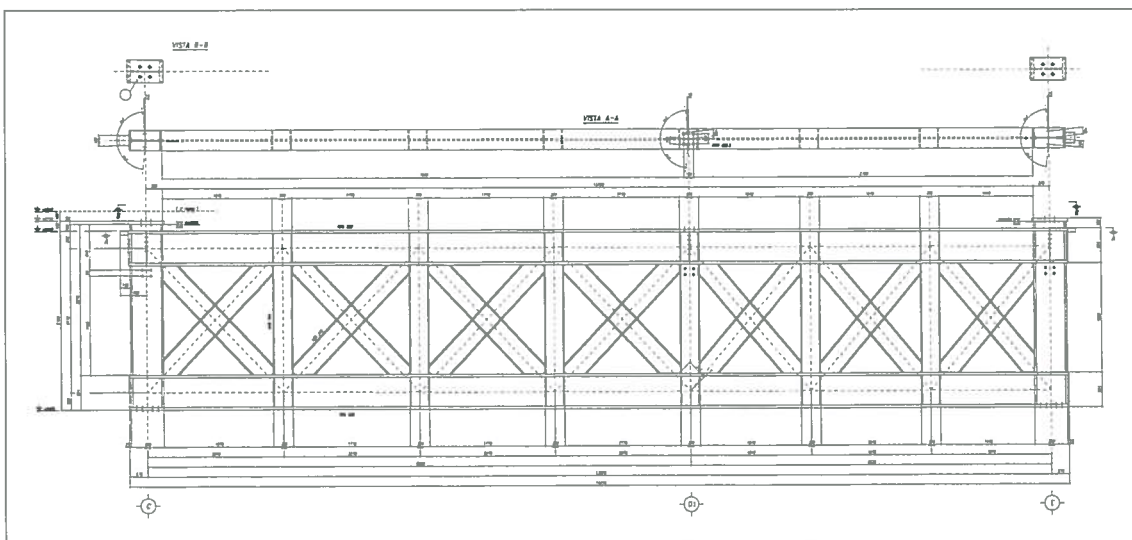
Progetto esecutivo della trave reticolare della hall di ingresso.
